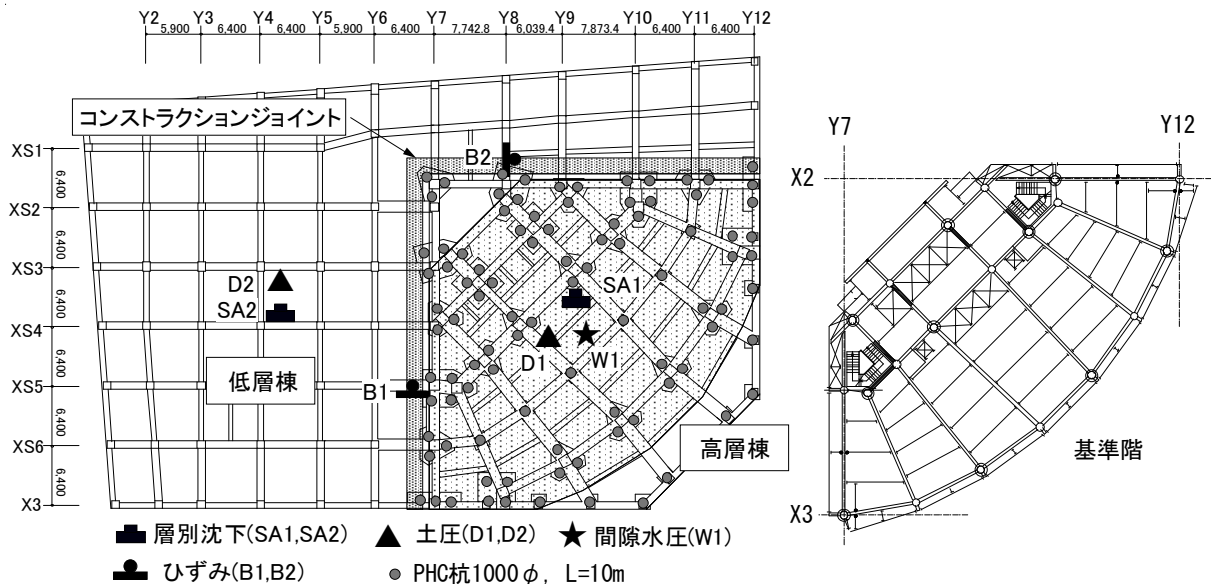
S ビルの地下 1 階伏図，杭配置図および計測配置図
